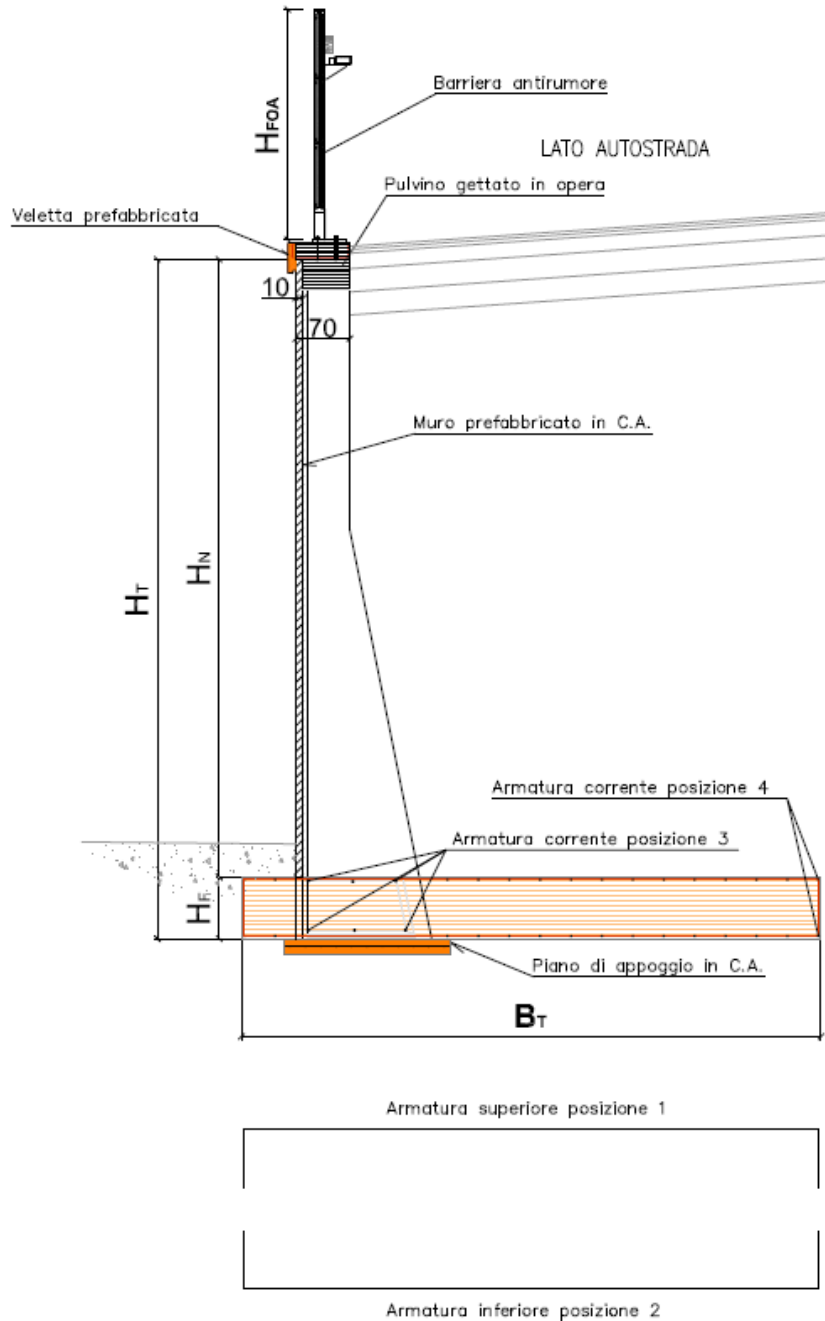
Sezione tipo muro prefabbricato, con schema armatura della fondazione
